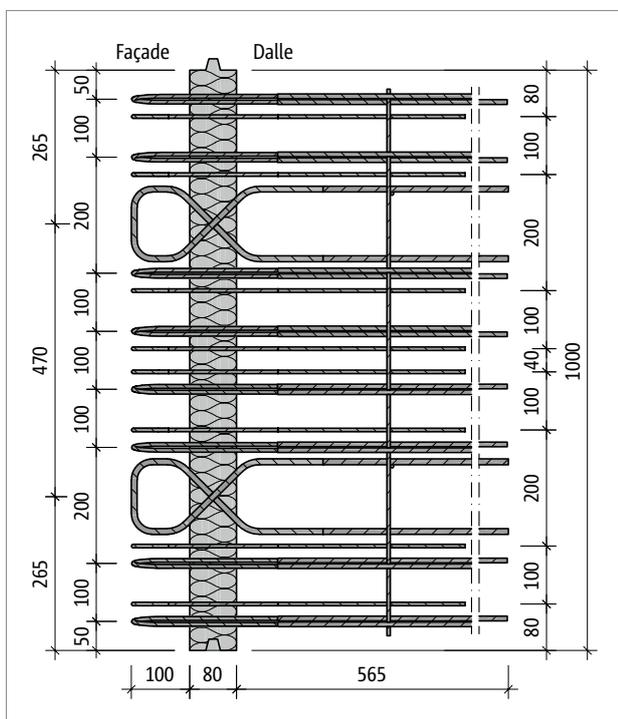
Schöck Rutherma® T type DF-S-V6-LR100 : vue en plan du produit
